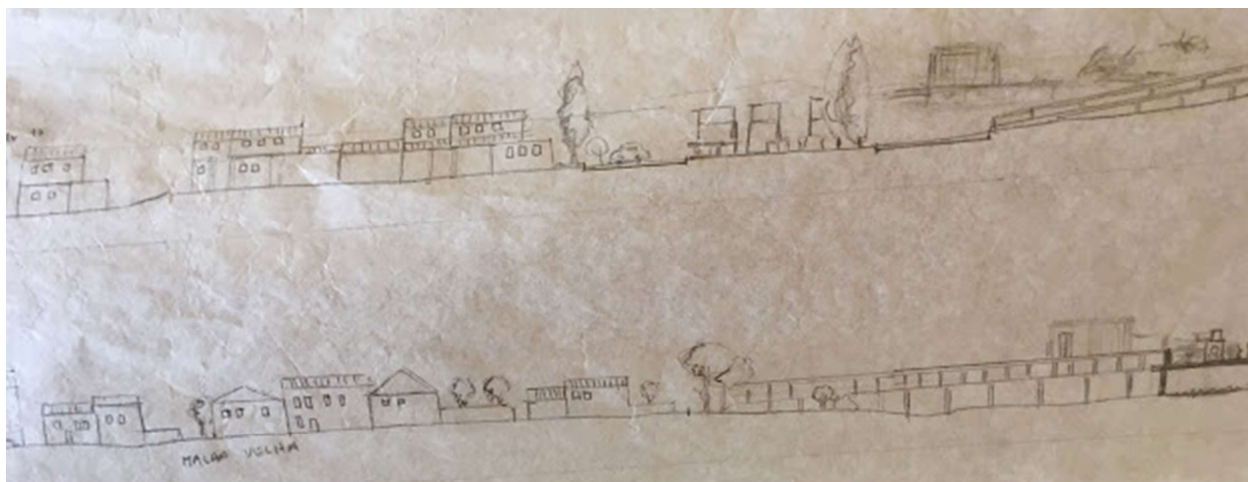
Primeiros Estudos de Implantação – Setembro-Outubro 2018
